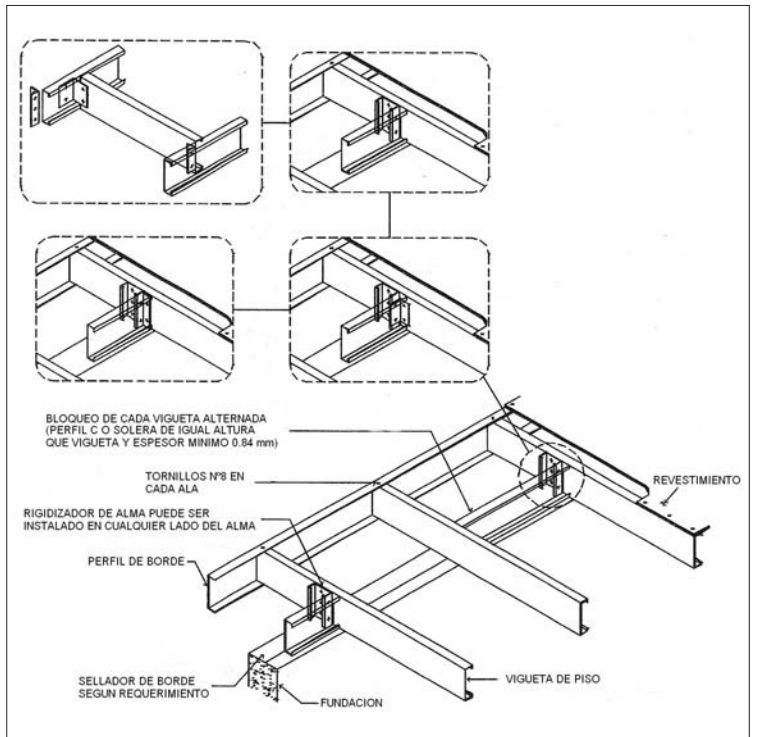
Conexión de Piso en Voladizo a Fundación
